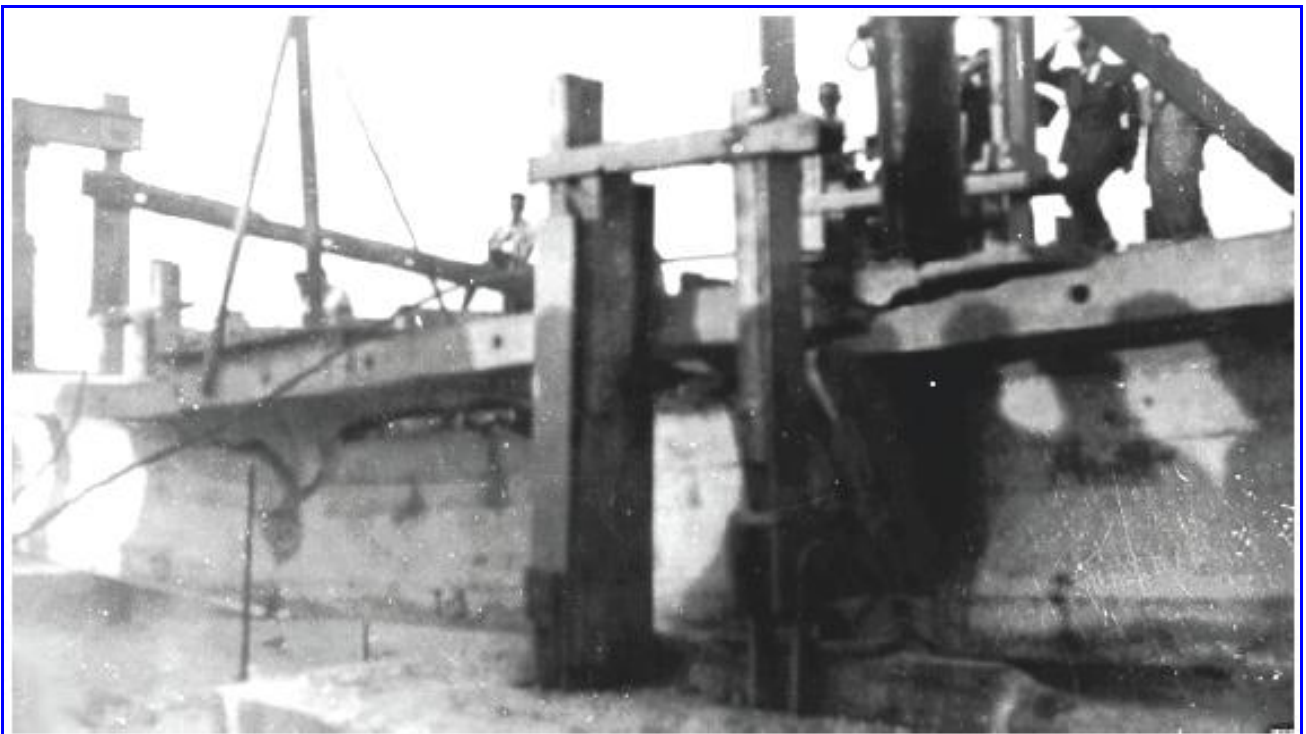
Prova de carga de viga pré-moldada pós-tensionada da Ponte do Galeão,
